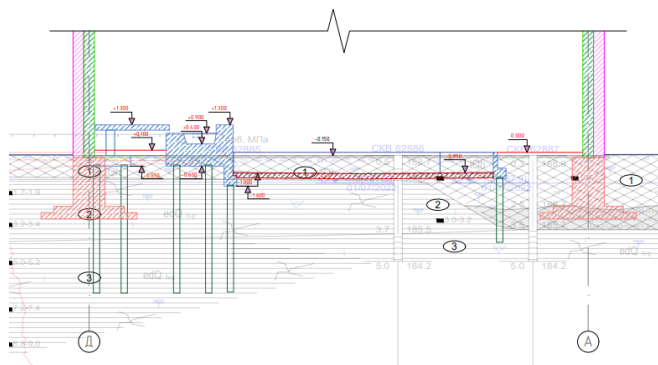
Поперечный разрез промышленного железобетонного каркаса с указанием встраиваемых объектов в эксплуатируемое сооружение.
